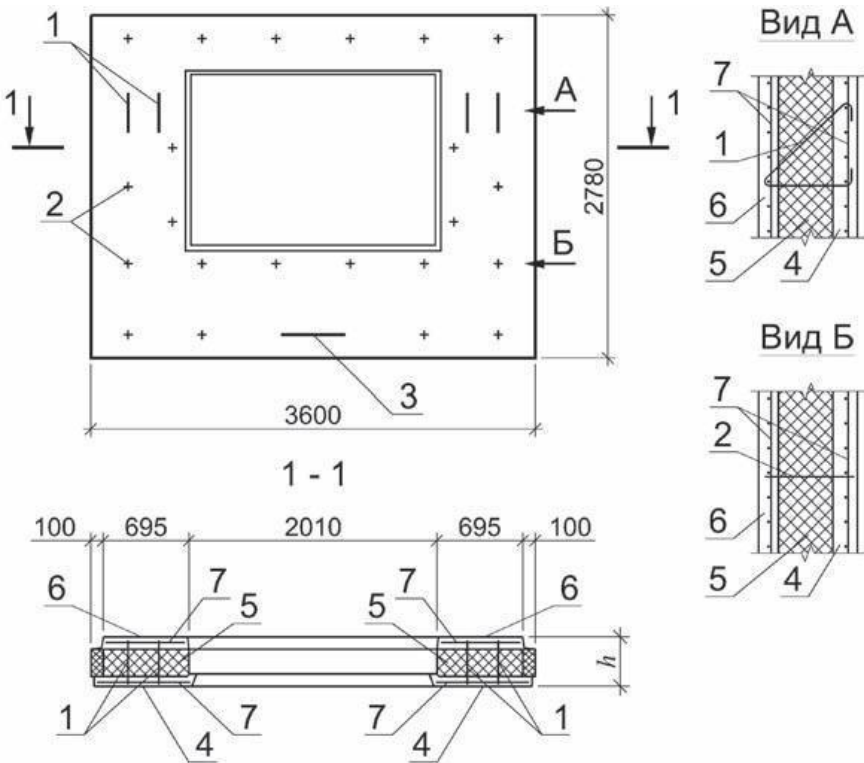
Трехслойная панель наружных панельных зданий:
